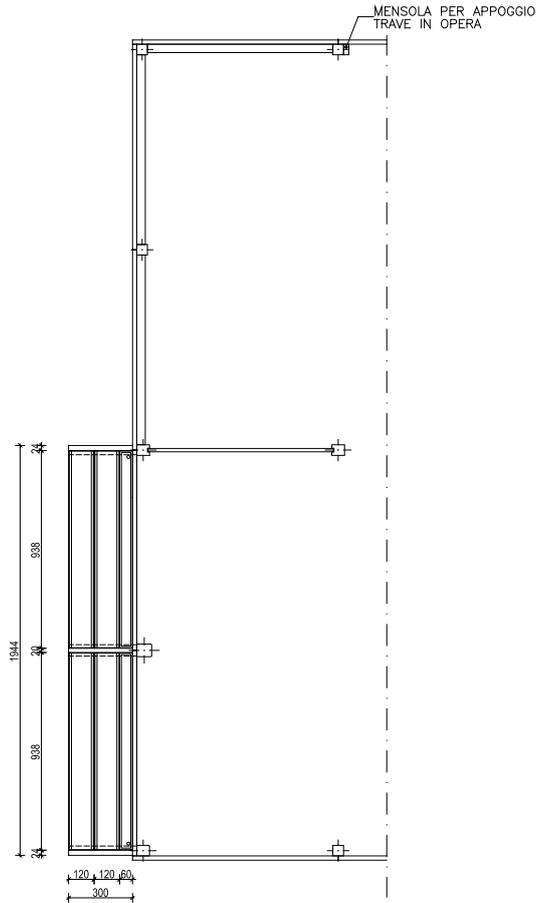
Particolare pianta edificio prefabbricato monopiano (anno 1996)
